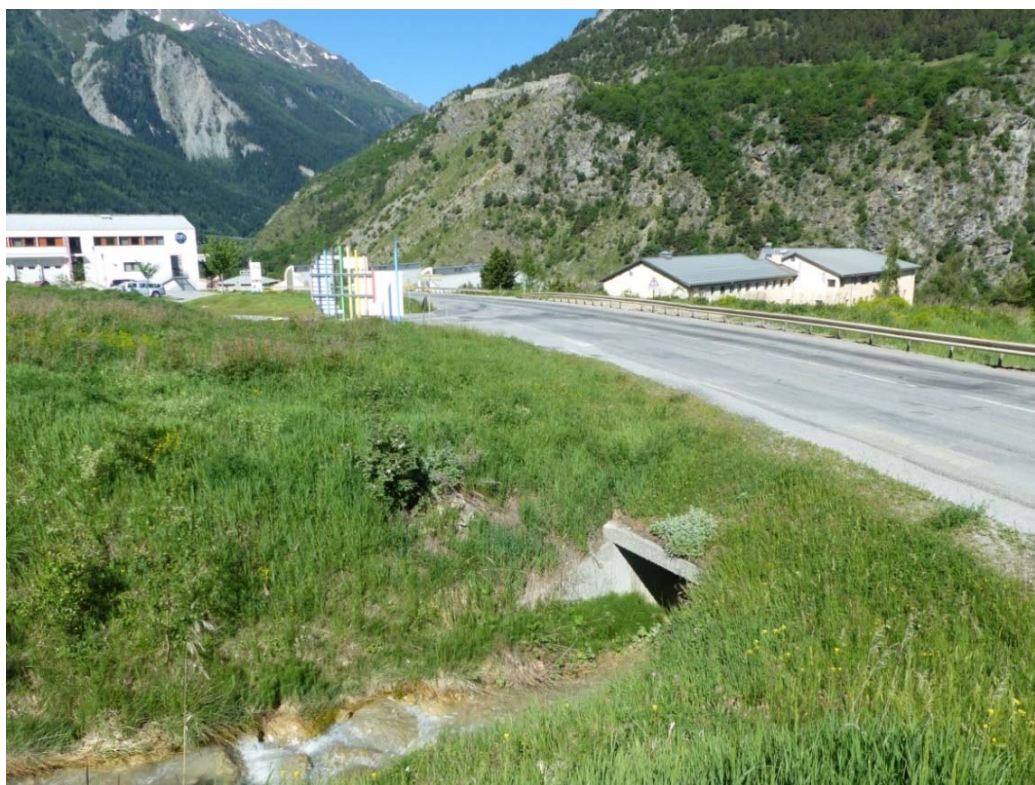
vue sur le bas du secteur de projet et le ruisseau sous la RD216
